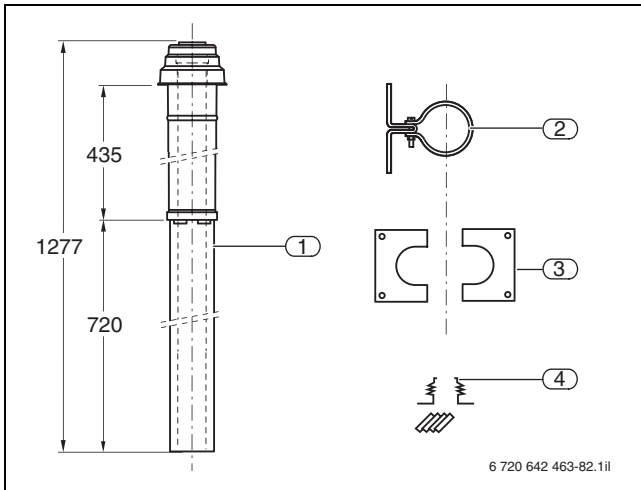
Bauteile des Grundbausatzes DO aus Kunststoff (Maße in mm)
